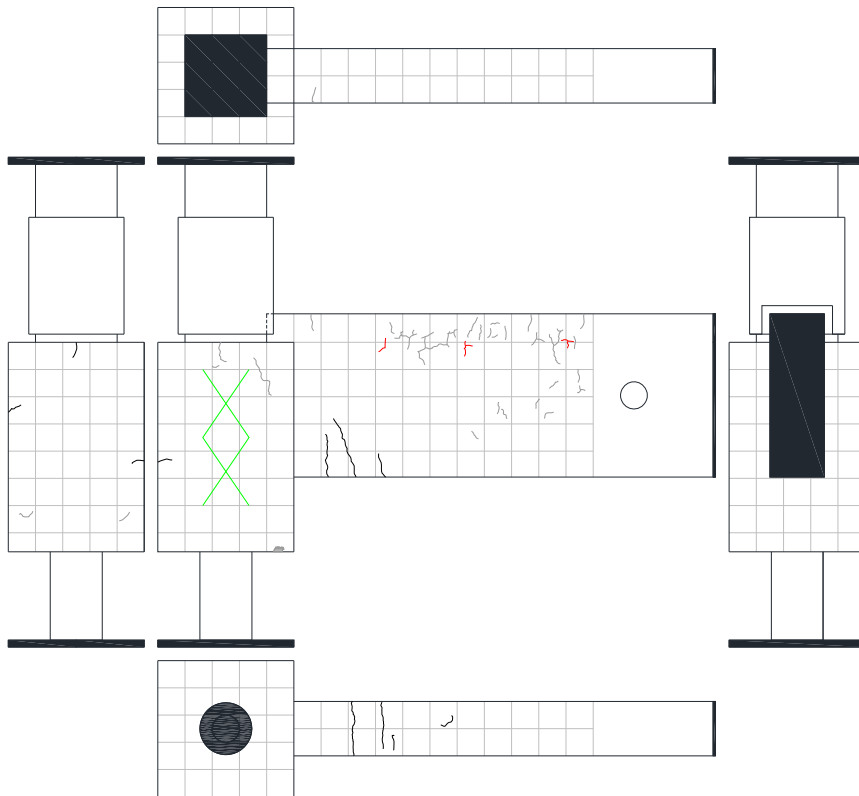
試験体 D-3 ひび割れ状況 (10Cycle)
